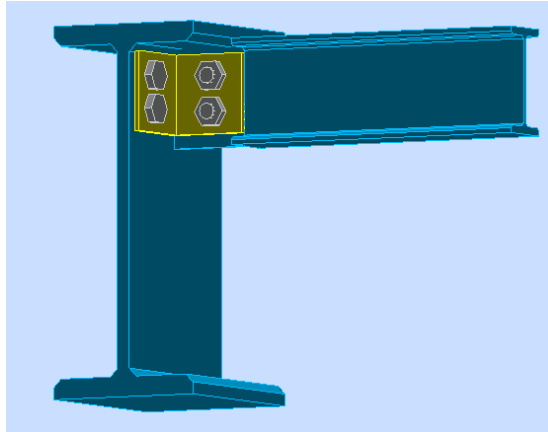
Diseño unión viga inferior interior- viga (10m)
